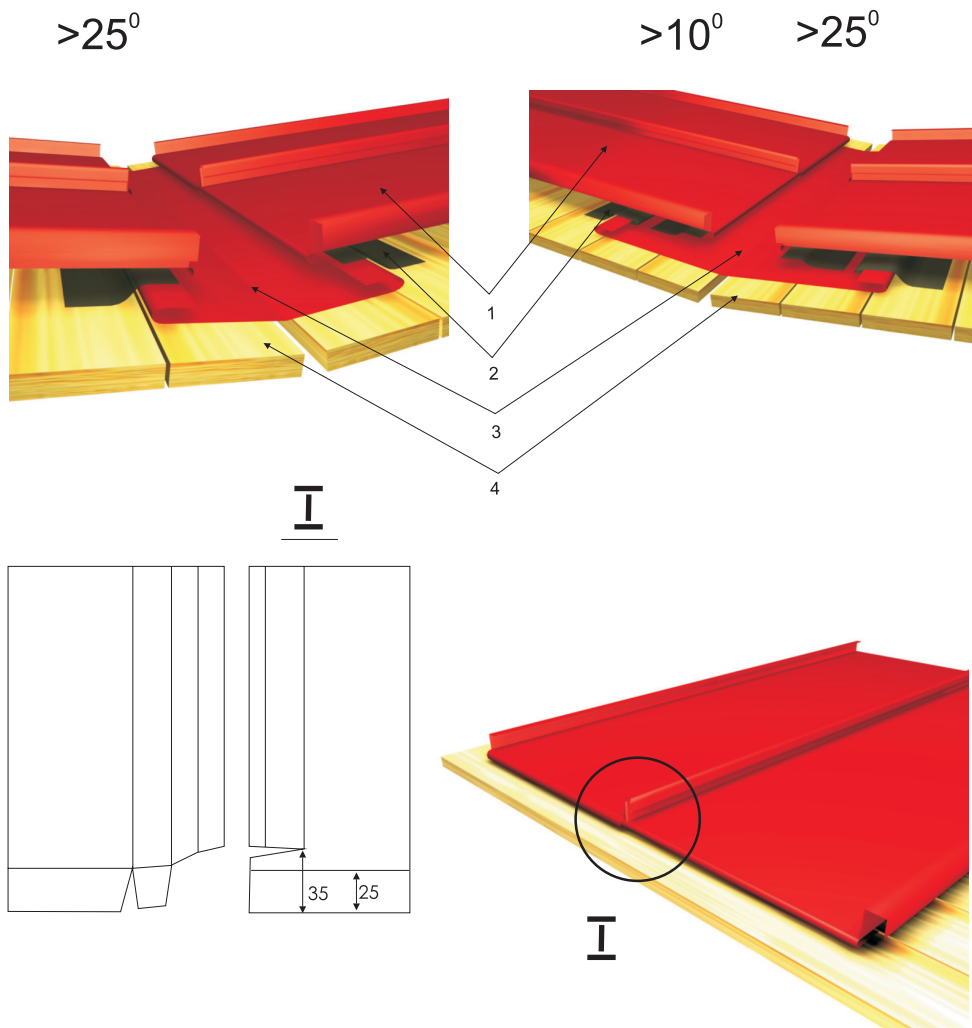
Крепление водоотводных желобов (ендов) и соединение их с рядовыми листами кровельного покрытия.
